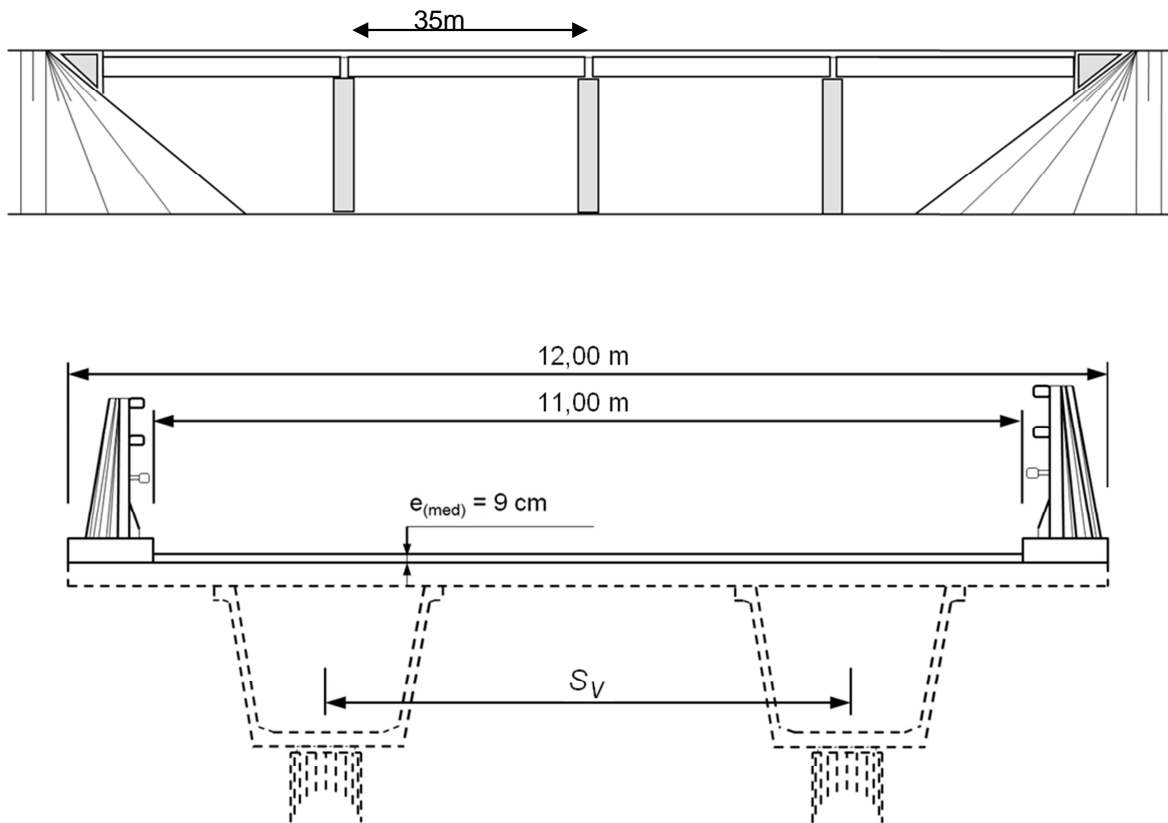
Esquema longitudinal del puente y sección transversal del tablero.
